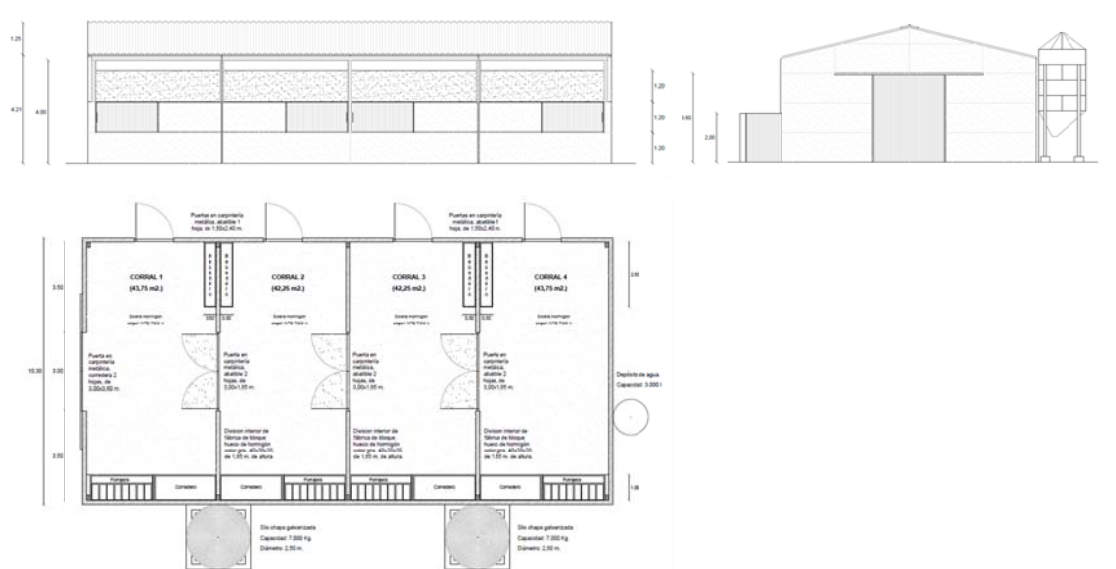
Planos de alzado, planta y perfil de una nave ganadera.
